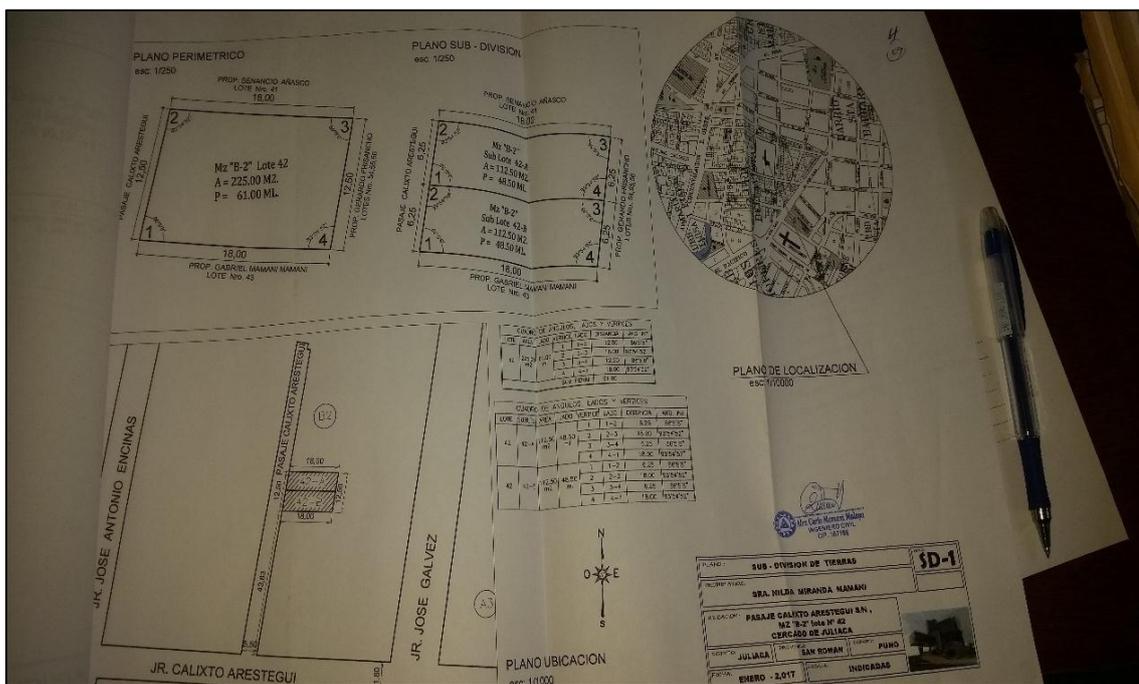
Modelo de plano de localización, ubicación y subdivisión.
